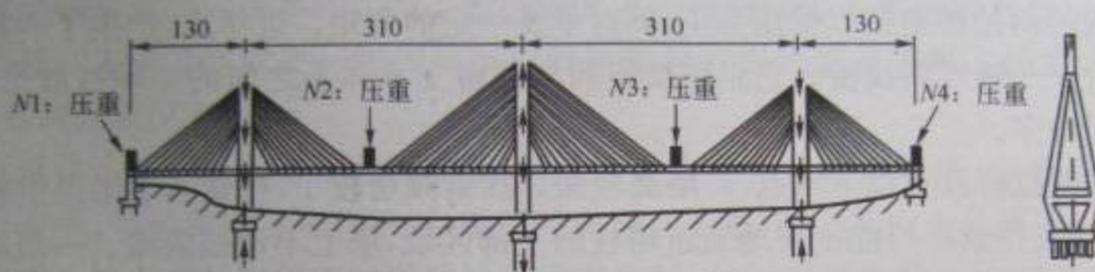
湖南岳阳洞庭湖大桥(尺寸单位:m)
